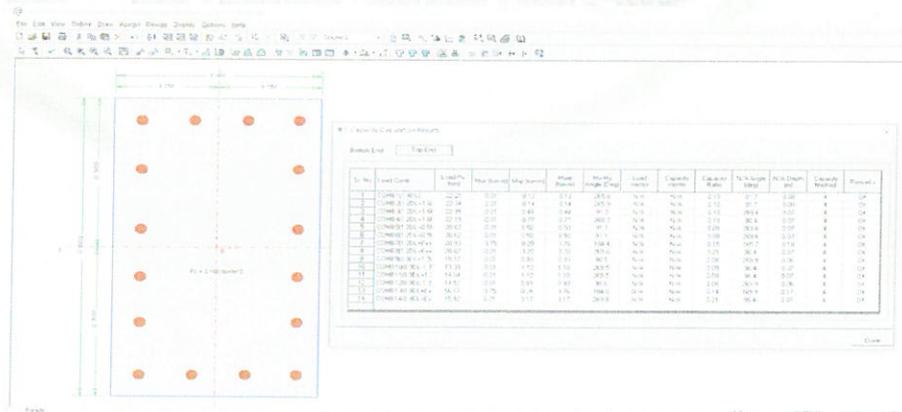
Vista de la capacidad de la sección de la columna en la parte superior
